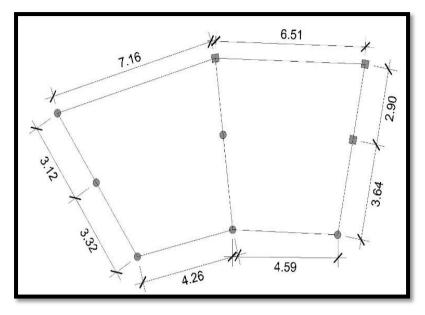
Modulación estructural bloque 04. (Fuente: Elaboración propia - 2017
